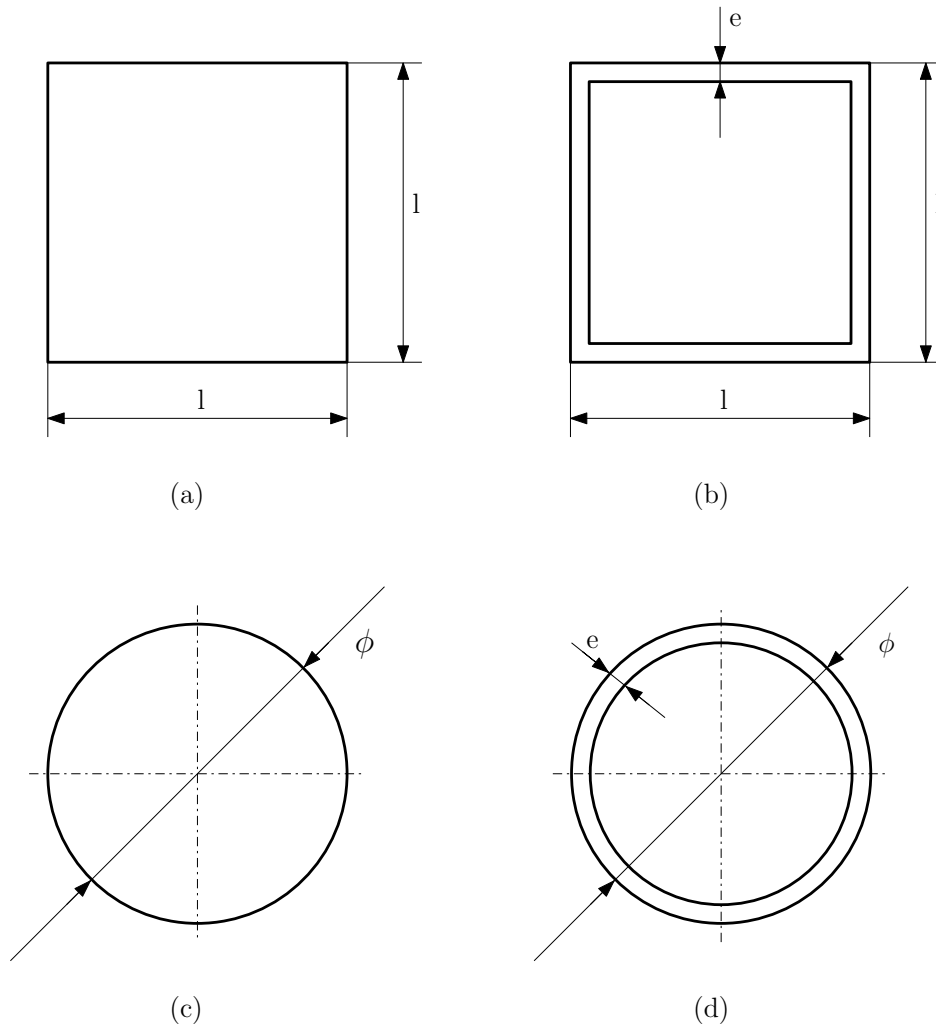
Características gerais das secções transversais utilizadas nos componentes das estruturas: (a) secção Q1, (b) secção Q2, (c) secção C1 e (d) secção C2.
